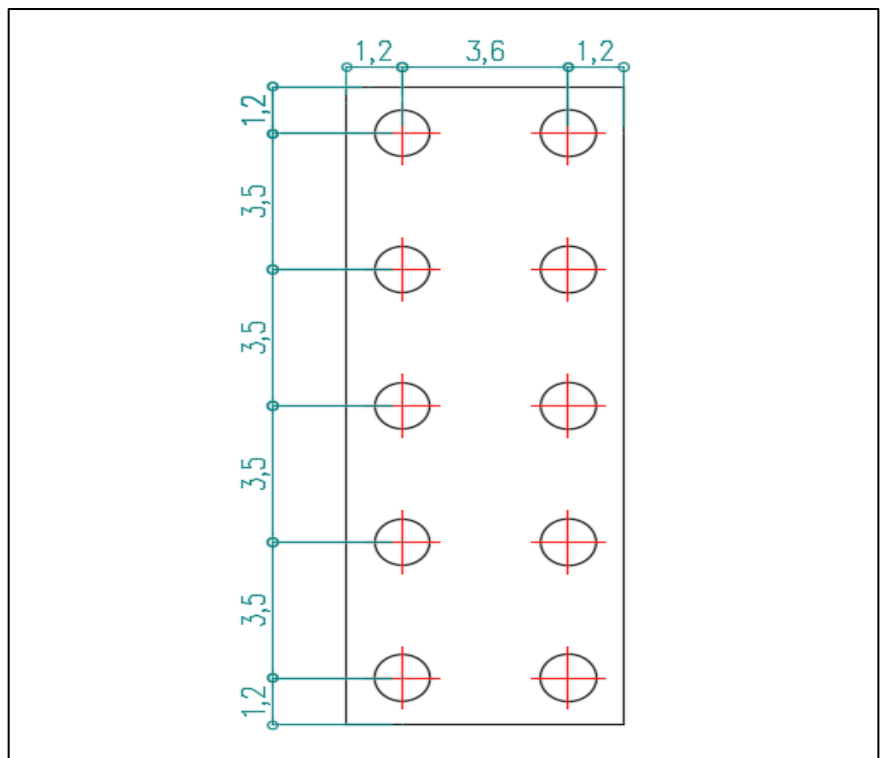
Plan de disposition des pieux sous la semelle
